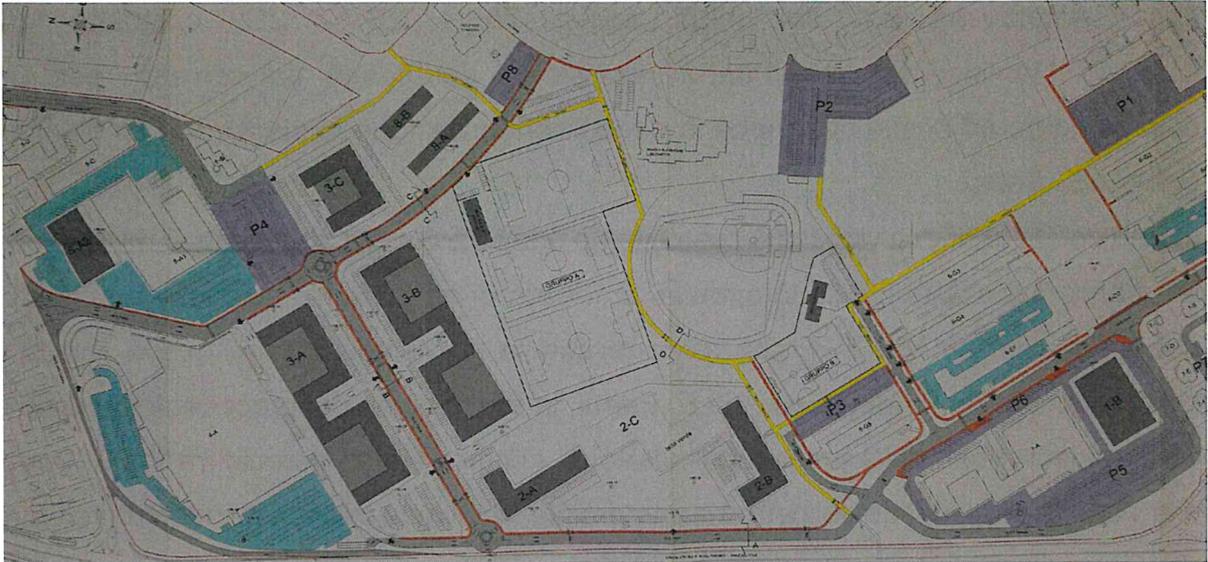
Estratto Tav. 16 P.I.R.U.E.A. POMARI
